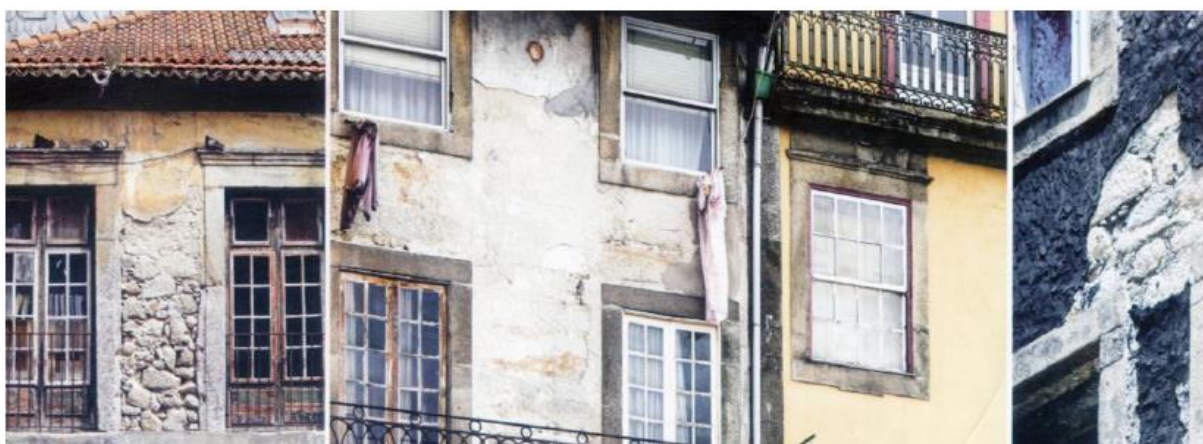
Exemplos de parede de fachada de rua de tardo de alvenaria, [19]
